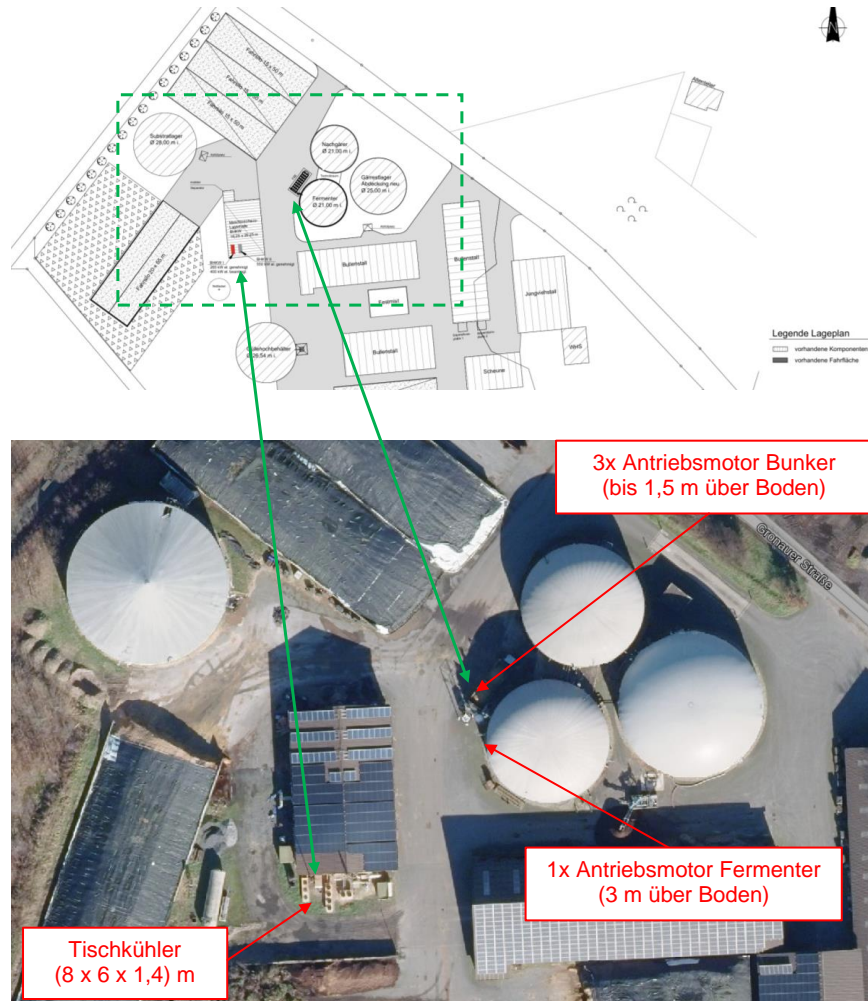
Lageplan (oben) und Luftbild (unten) mit Kennzeichnung der Lage der untersuchten Objekte
